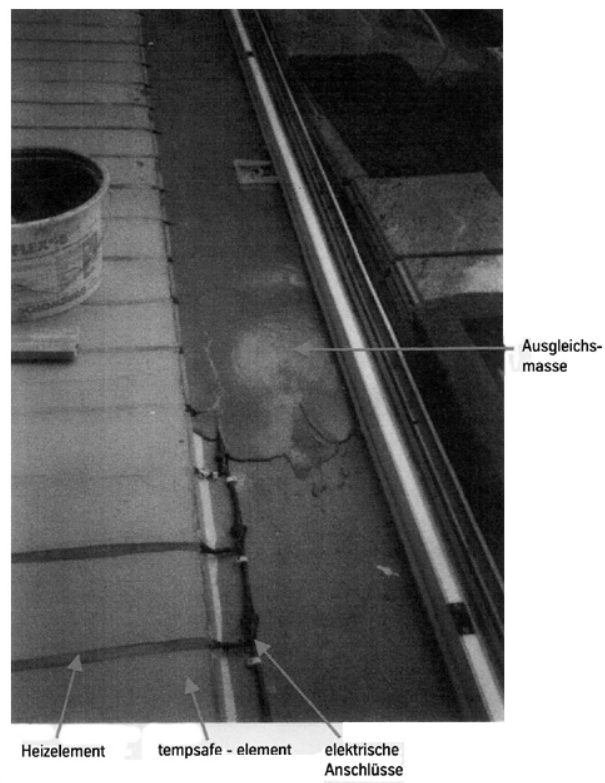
Gebäudeerweiterung mit Fußbodenheizung und Dämmung durch tempsafe® elements mit einem Konstruktionsaufbau von 26 mm
